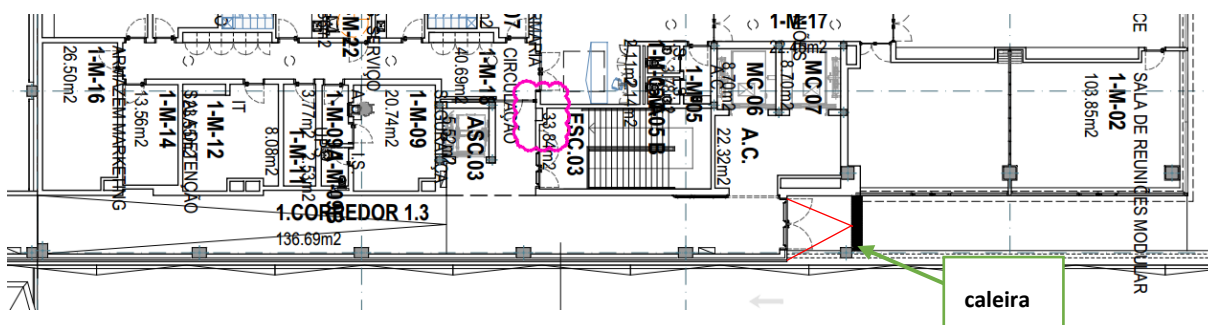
Planta Arquitetura, Piso 1 – Administração (Pendente 1.5% da Porta à caleira)
